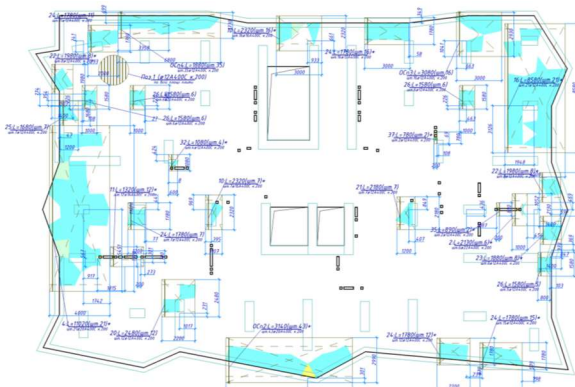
Арматування плити перекриття: верхня арматура вздовж осі Y
